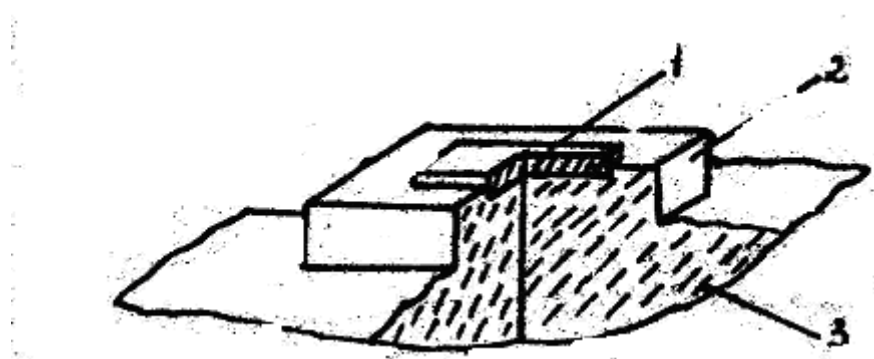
Бетонная подушка с металлической подкладкой: 1- подкладка; 2- подушка; 3- фундамент
